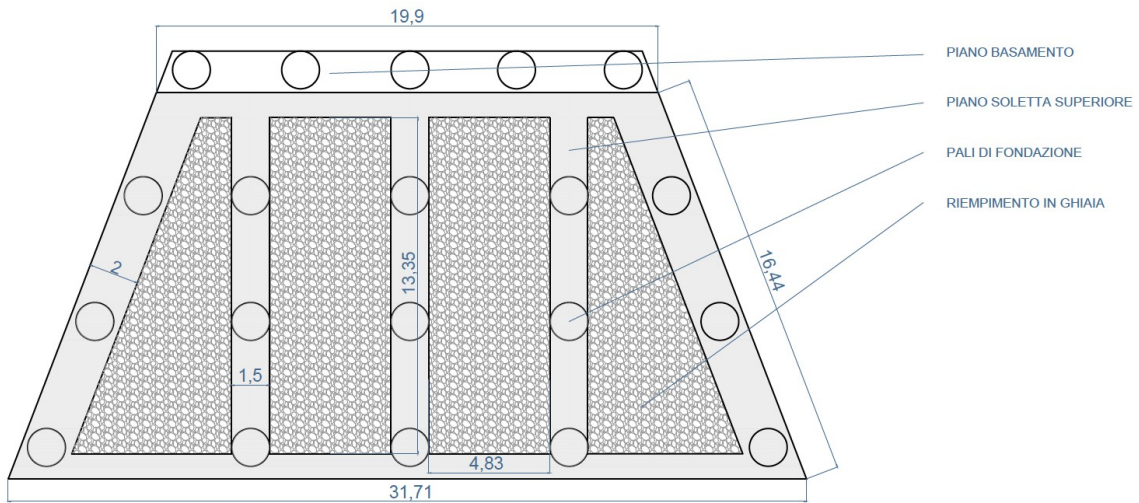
sezione orizzontale spalla zavorrata, quotata in m
